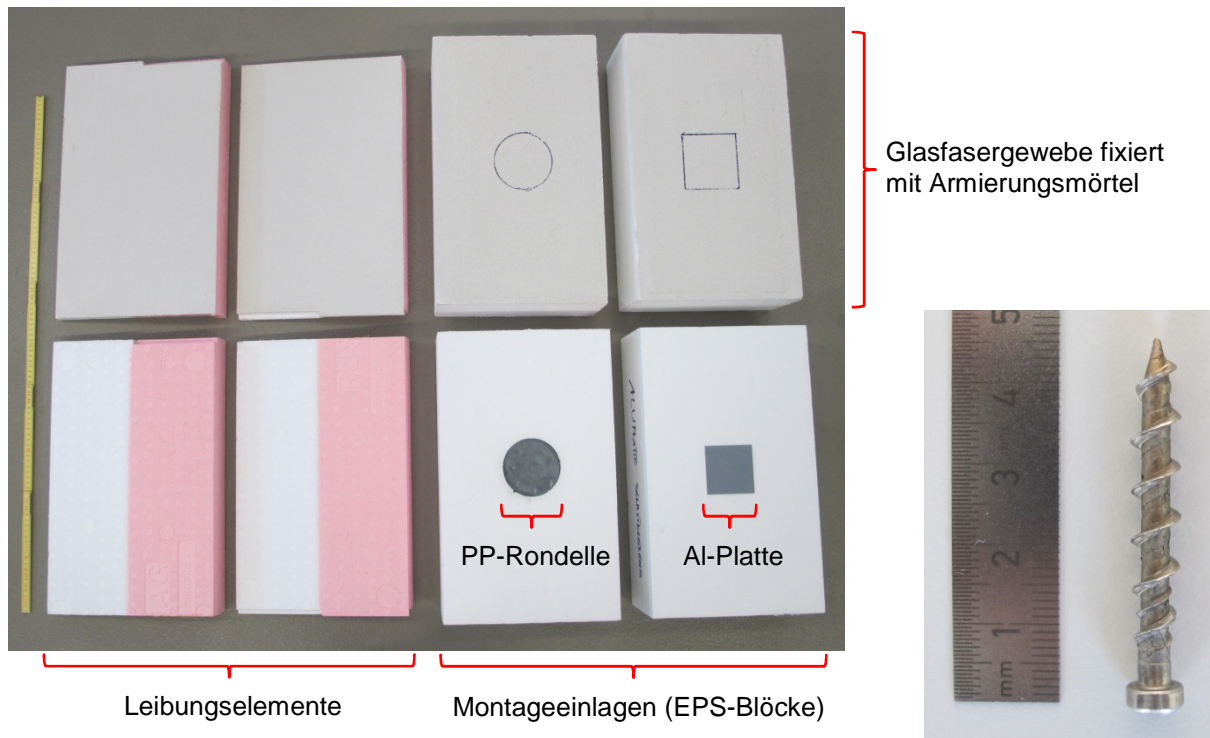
Leibungselemente, Montageeinlagen befestigt auf EPS-Blöcken und Flachkopfschraube [Empa-Nr.: 5214014282/01]
